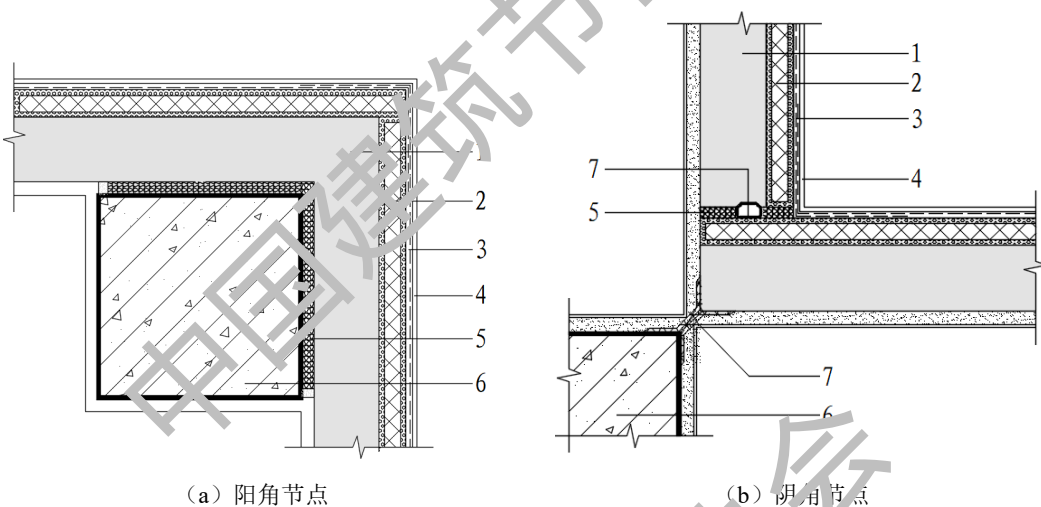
真空绝热预制混凝土保温外挂墙板接缝节点构造示意图
